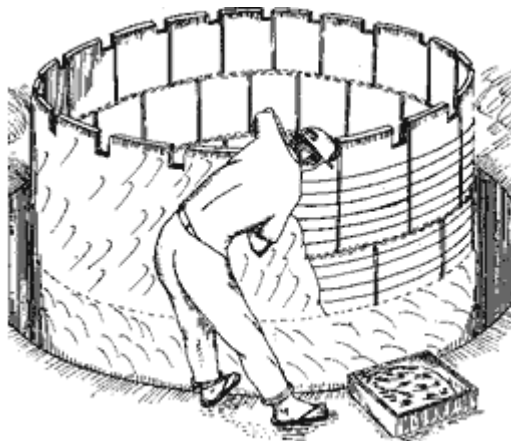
Armação da parede e reboco externo de cisterna de placa
